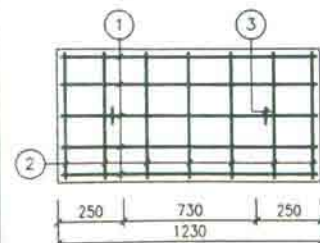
号~7号钢筋混凝土化粪池 盖板平面布置图	图 集 号	91SB4-1
